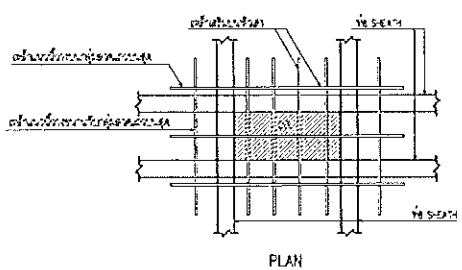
การเสริมเหล็กบริเวณพื้นที่กับ LIFT CORE / SHEAR WALL
